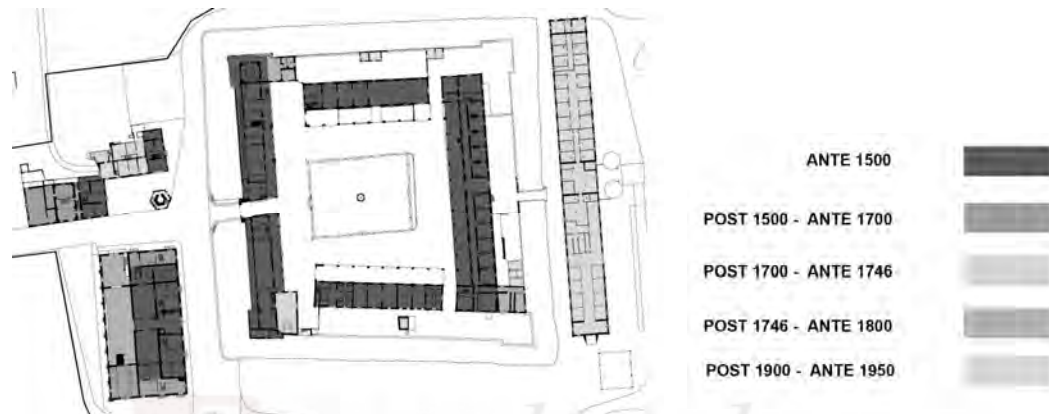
Planimetria con datazione dei corpi di fabbrica
